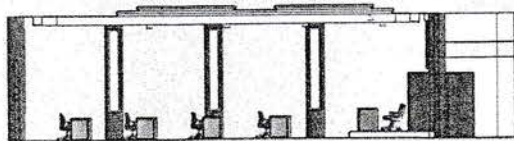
Layout Ruang Rapat Kantor Wali Kota
